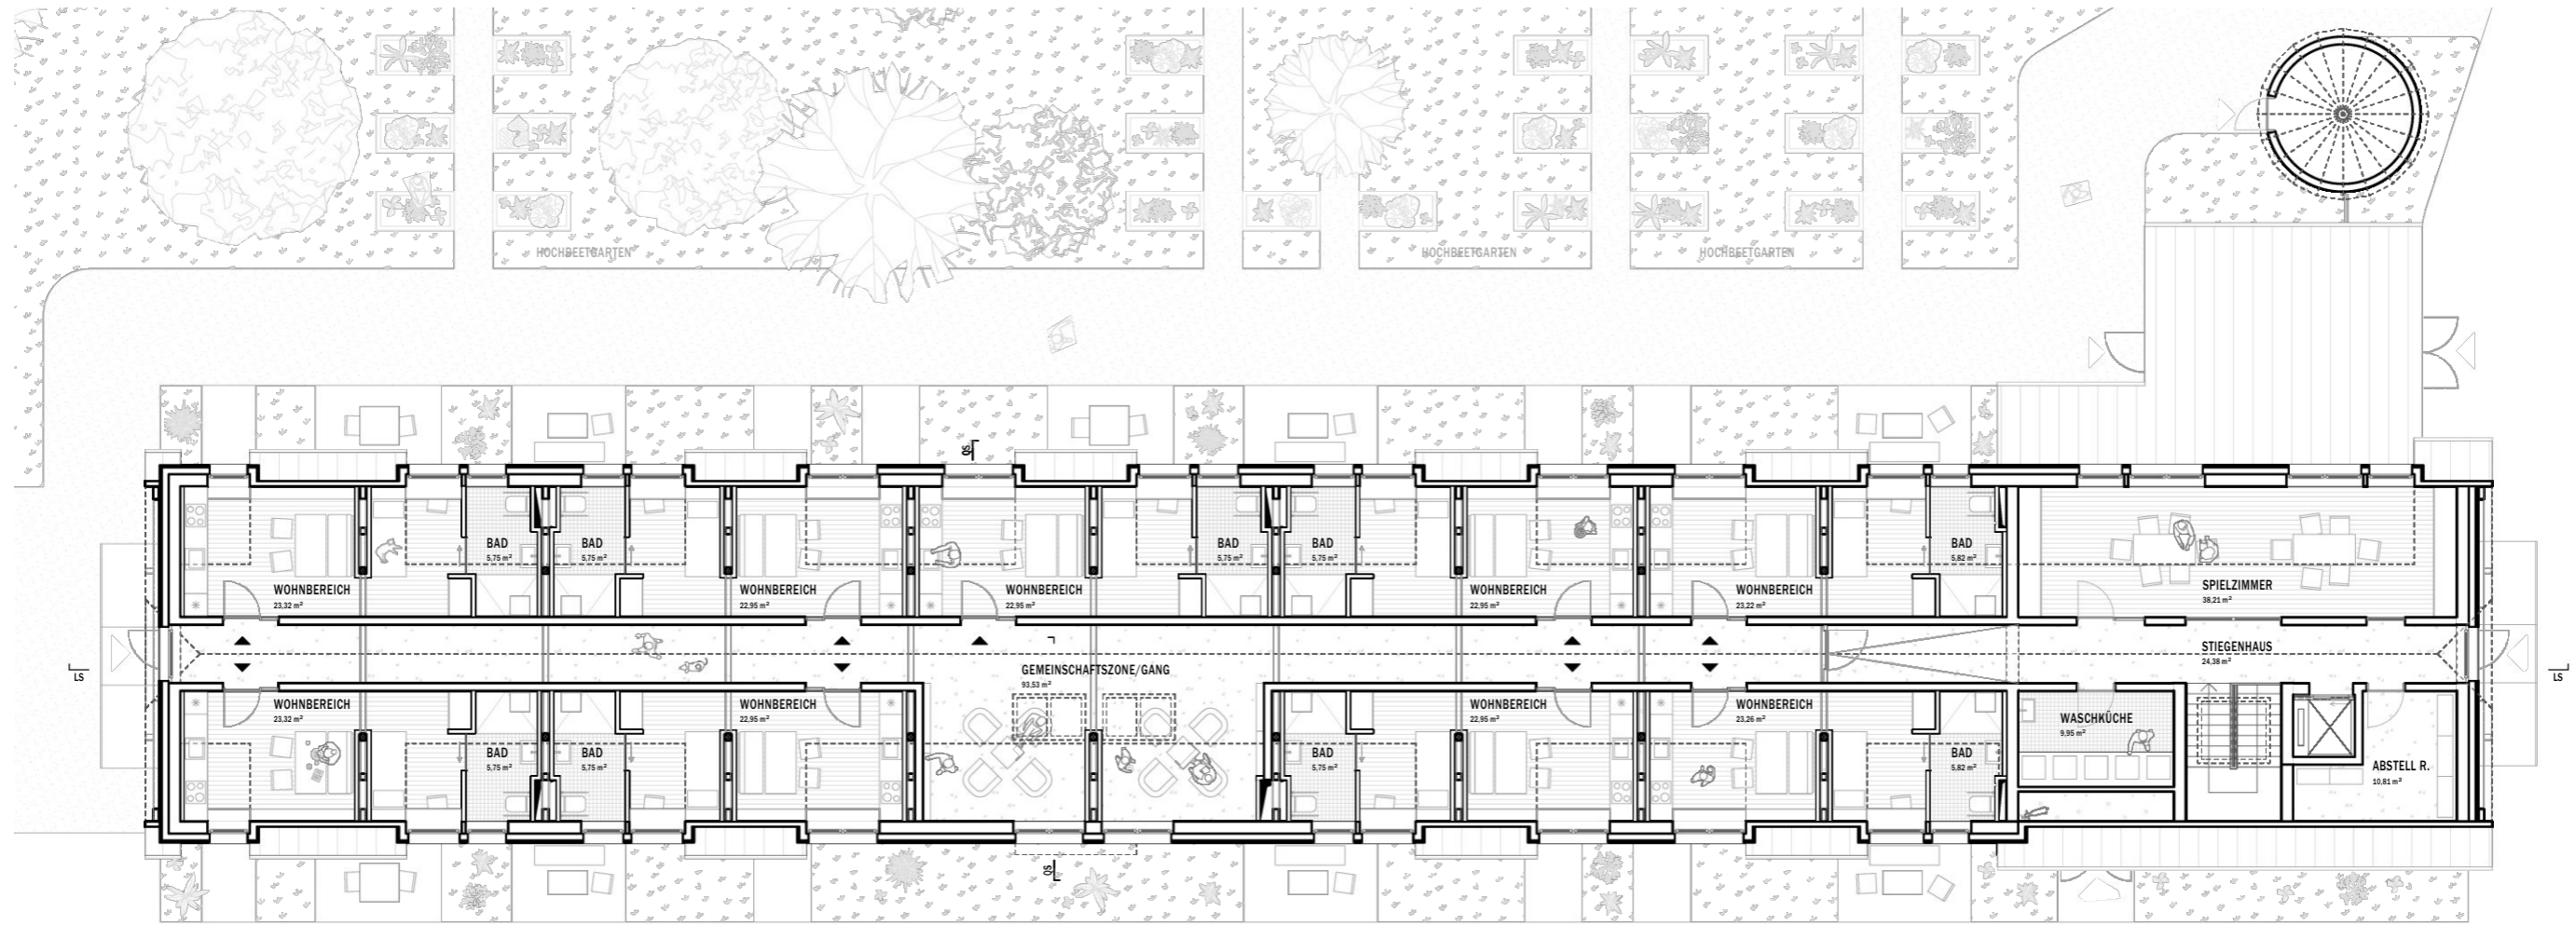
Grundriss OG, Umbau Stallgebäude
